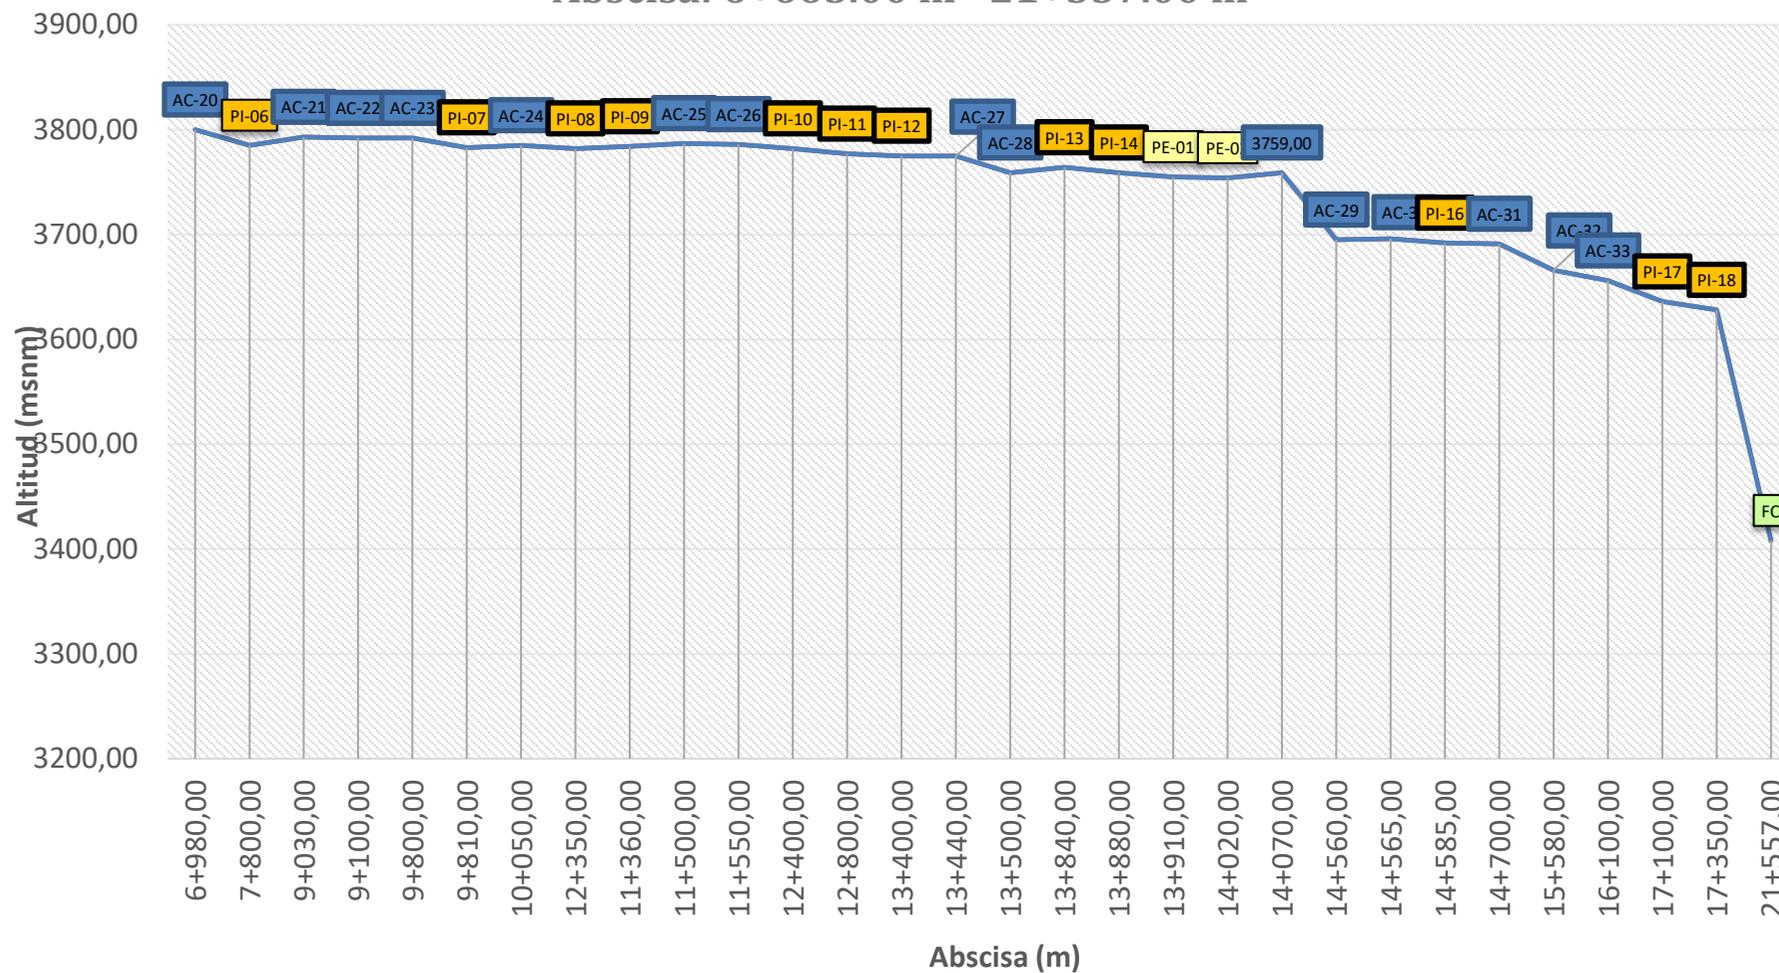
Perfil 2 del canal Gualay. Fuente: Elaboración propia.
